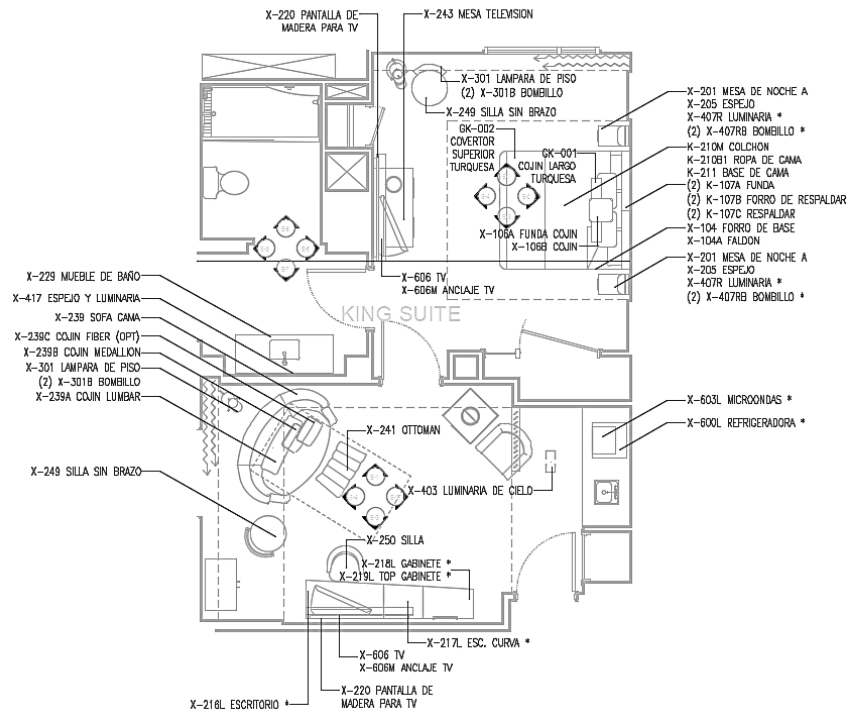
Planta de muebles King Suite Hotel Courtyard
